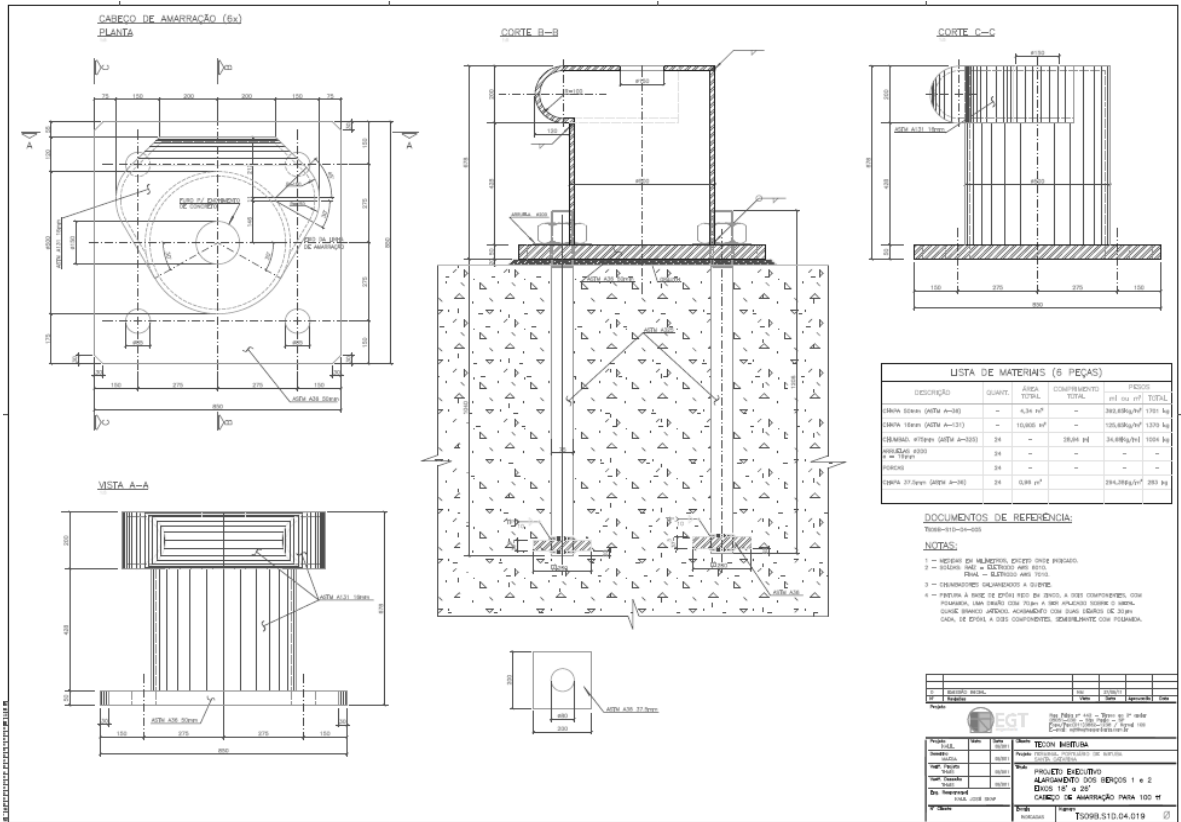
Detalhe do projeto nos eixos 18 a 26 de instalação do cabeço 100tf
